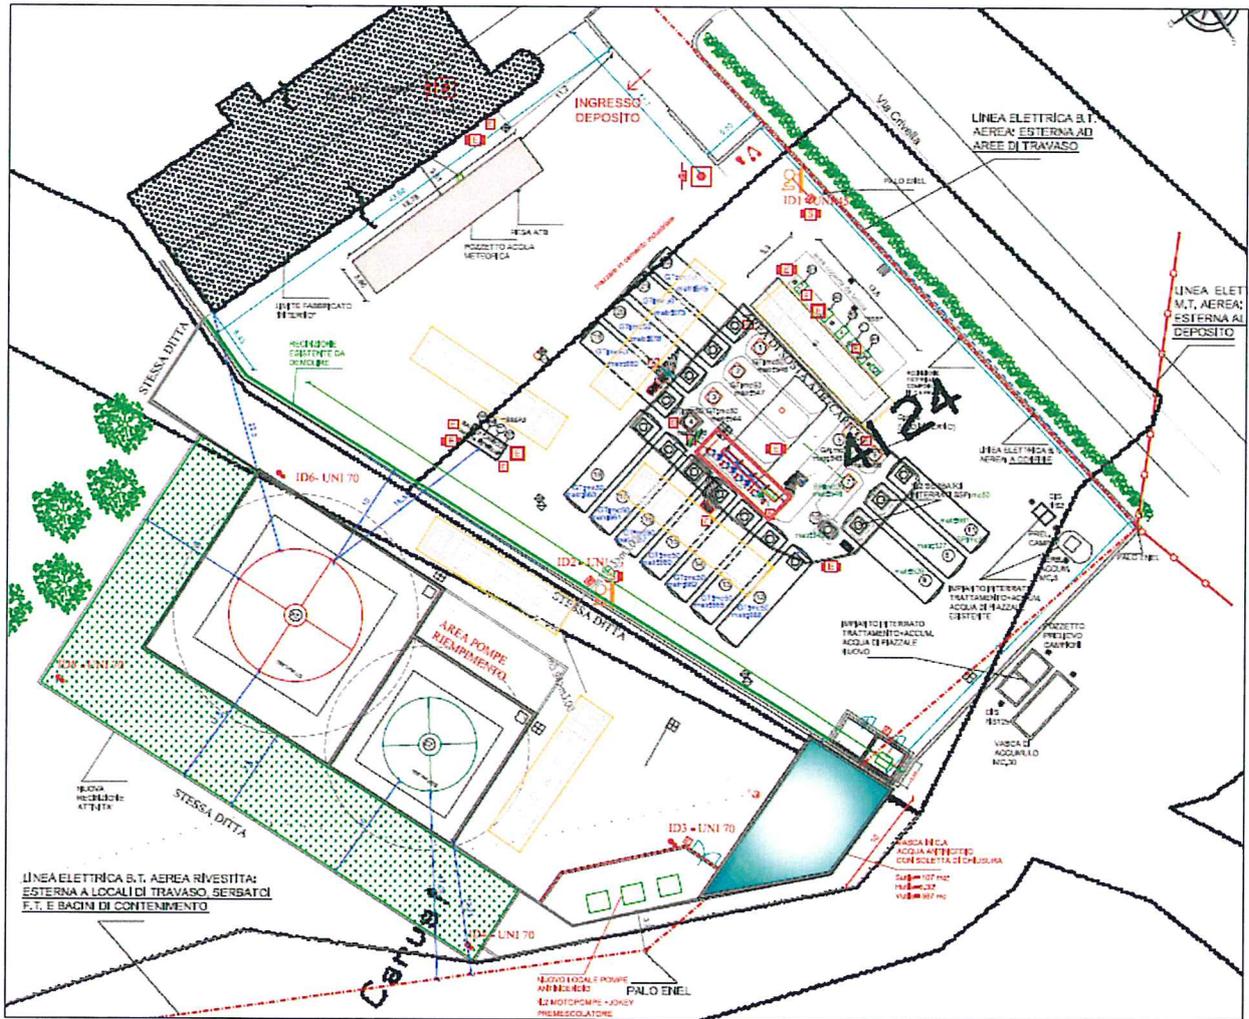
Planimetria di progetto (da Elab. T5 allegato allo SPA)
